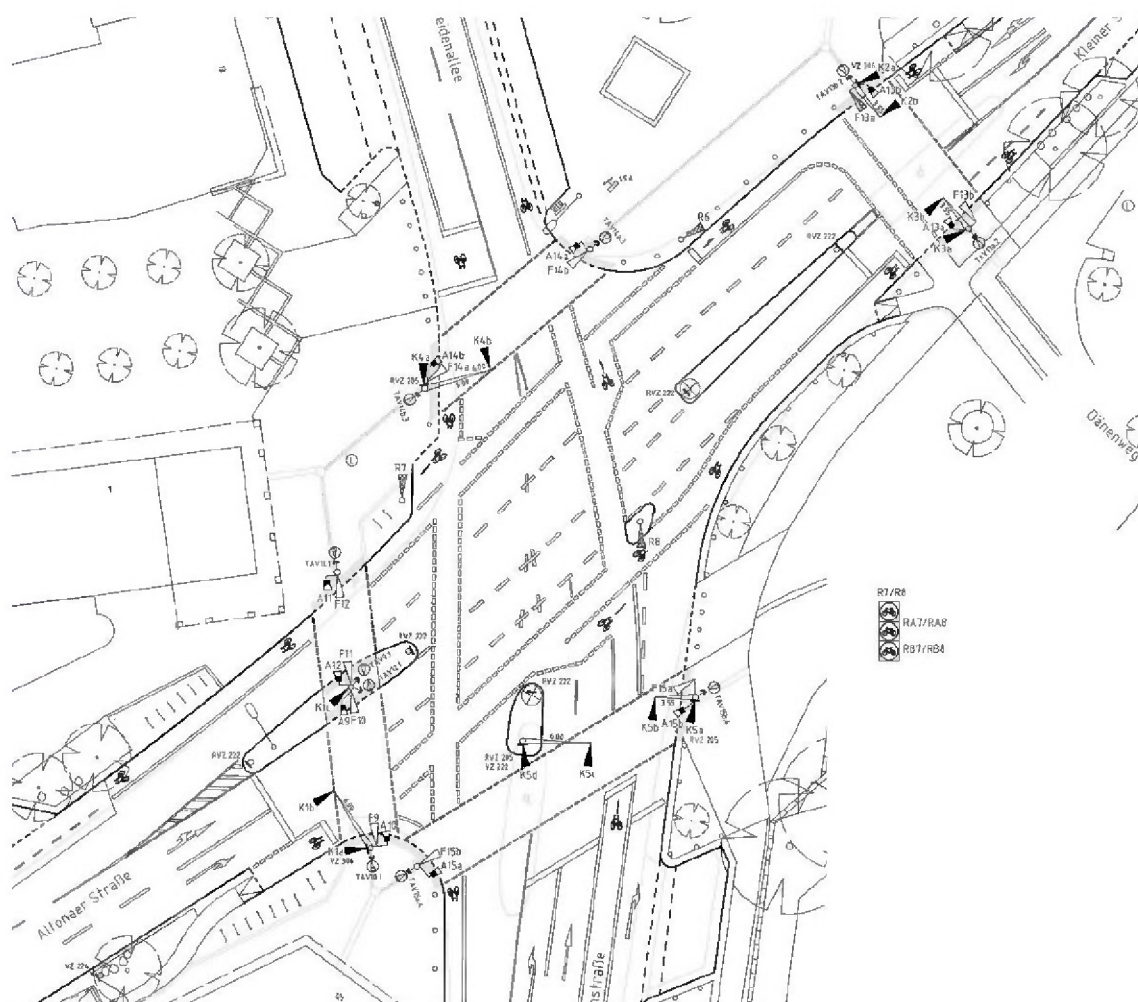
Signallageplan Kleiner Schäferkamp/Weidenallee – Bestand (18/219-04-06/00)
